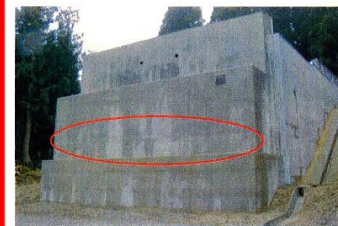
A1橋台完成(ひび割れ誘発目地)
